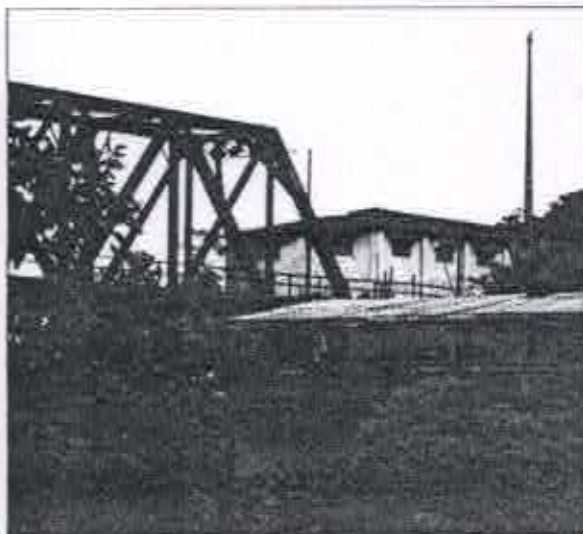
Edificações construídas muito próximas à ponte ferroviária.
